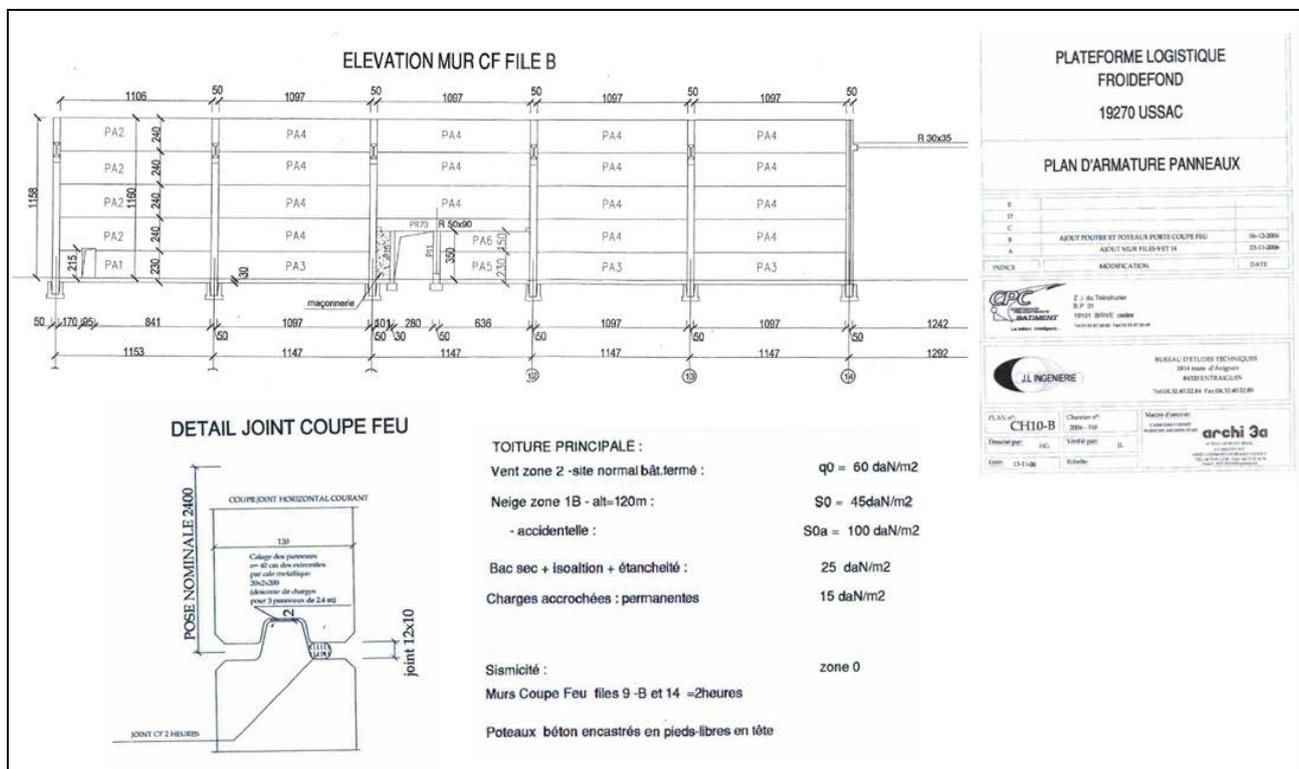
Extrait du plan d'armature panneaux après-travaux et détails techniques (Hors-échelle)
